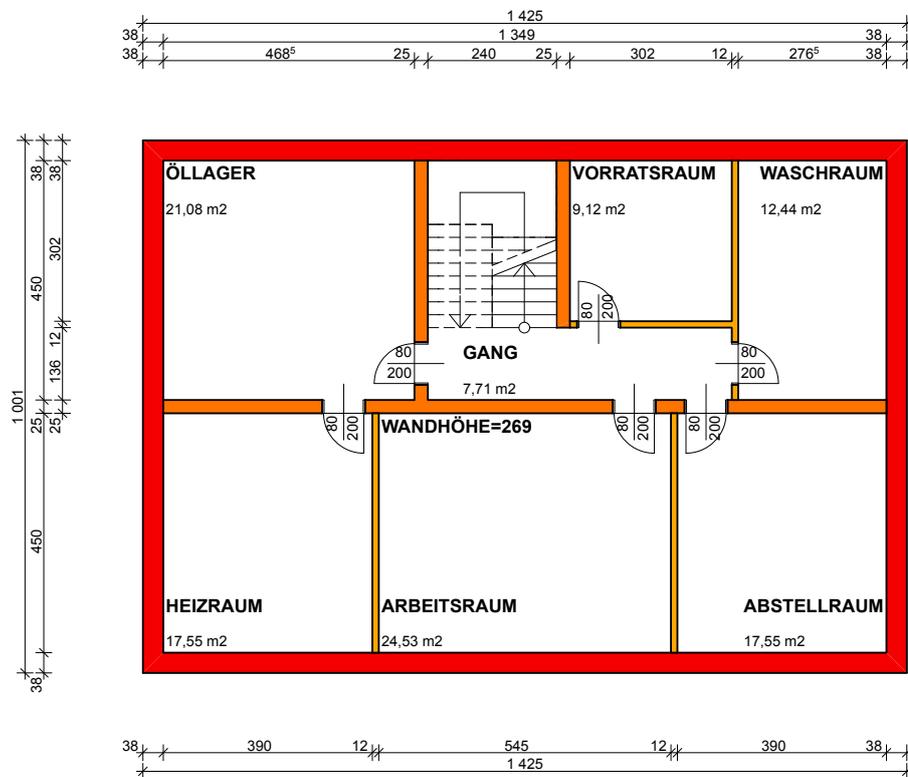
Grundriss Kellergeschoss
